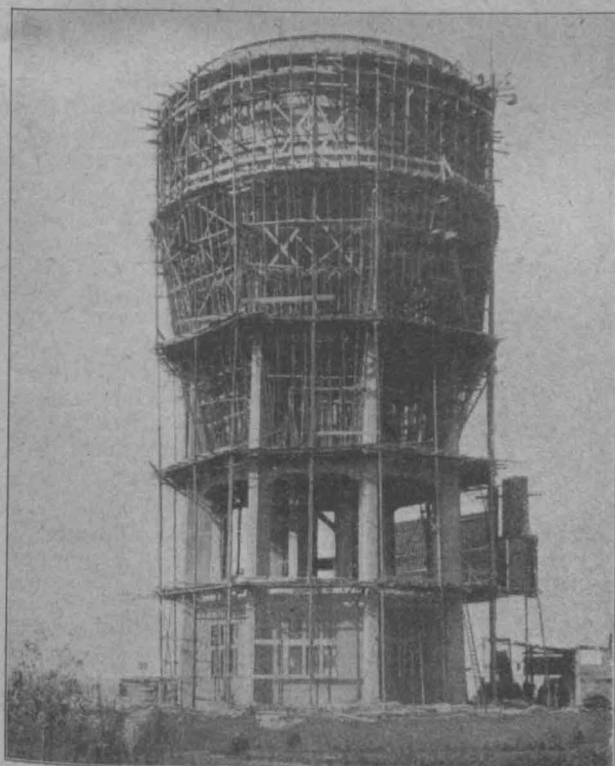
und b. Wasserturm für ein Industriewerk in Oberschlesien mit Eisenbetonbehälter von 2000 cbm Fassungskraft im Bau und vollendet.
